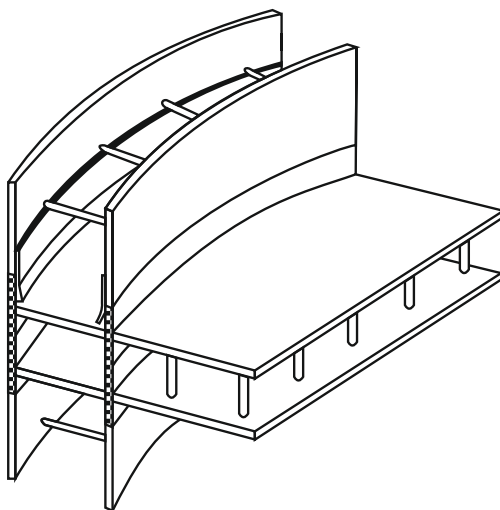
Фрагмент сопряжения трубобетонной стены элеватора со сталежелезобетонным перекрытием [10]
